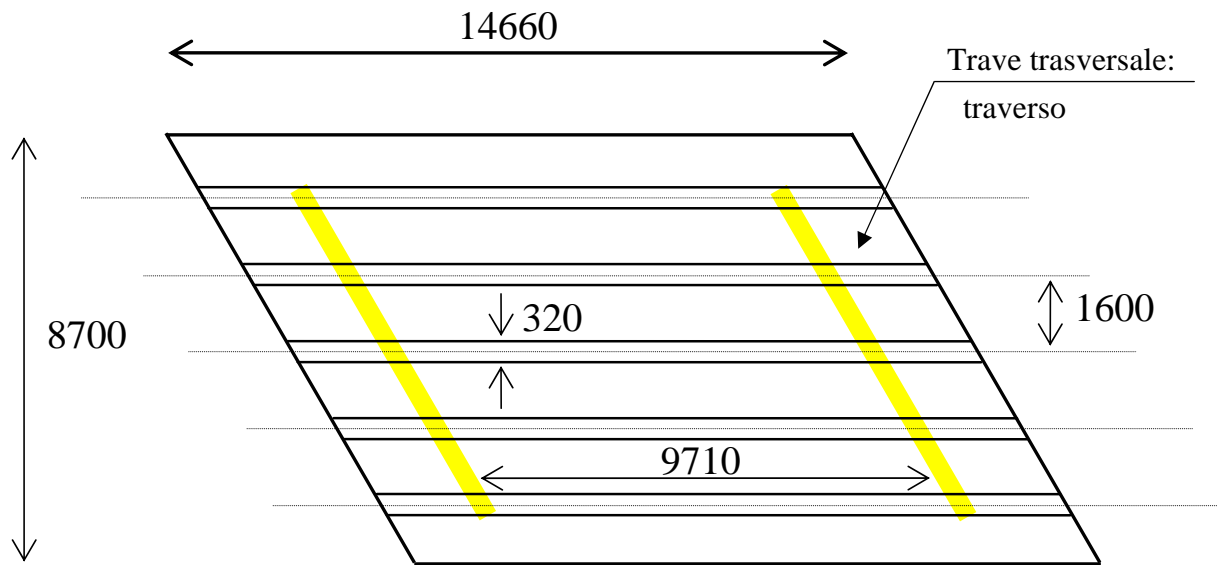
d: Pianta complessiva dell'impalcato nello stato iniziale.
